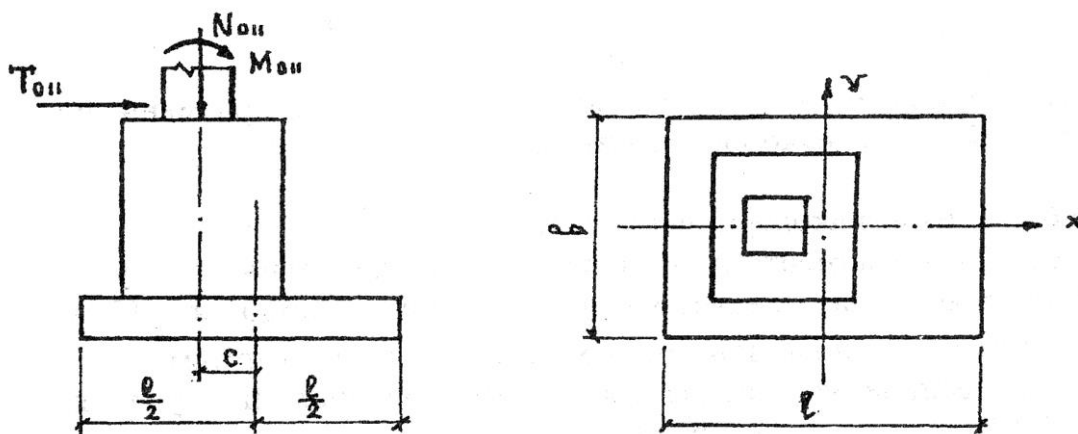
Пример конструкции фундамента с несимметричной подошвой
